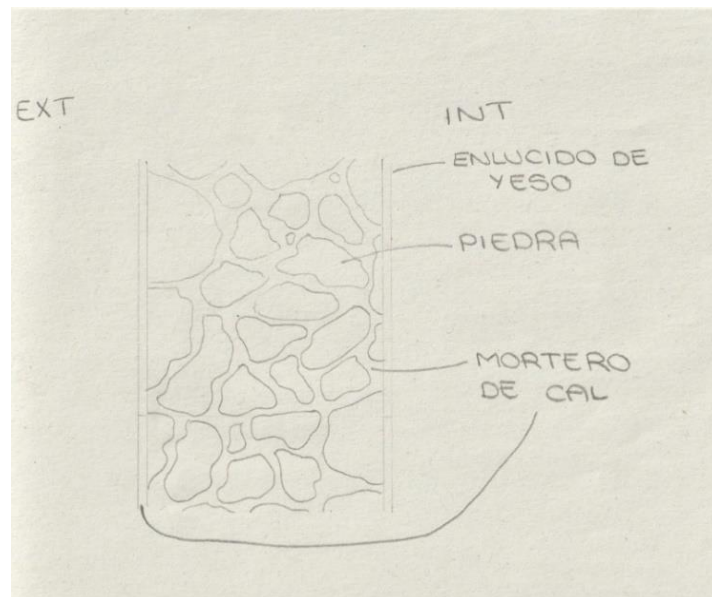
Detalle constructivo muro de carga de mampostería. Fuente: Propia.
